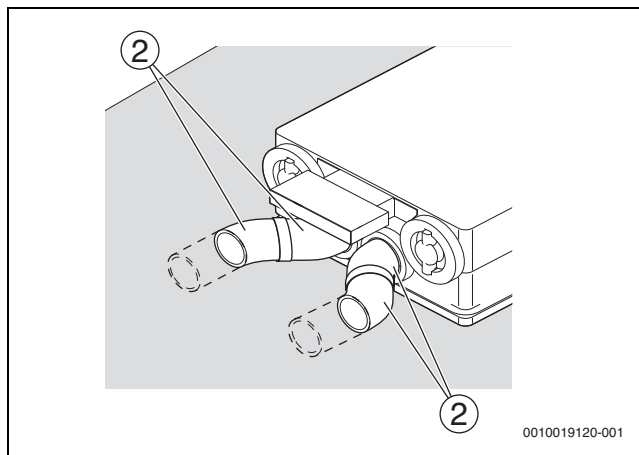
Dettagli di collegamento per fig. 39: disposizione dei tubi aria adduzione/ripresa
